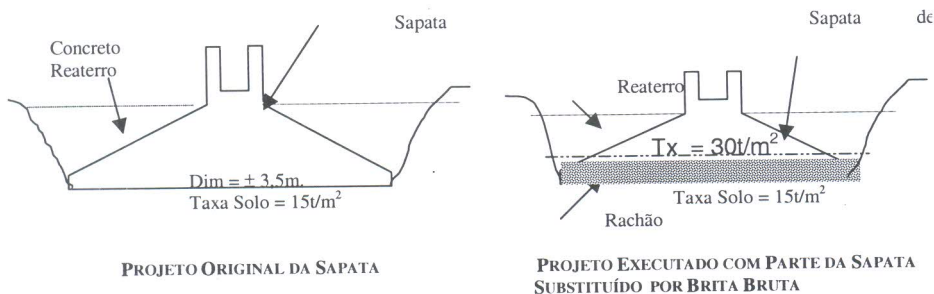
PROJETO DA SAPATA DE CONCRETO E RACHÃO
